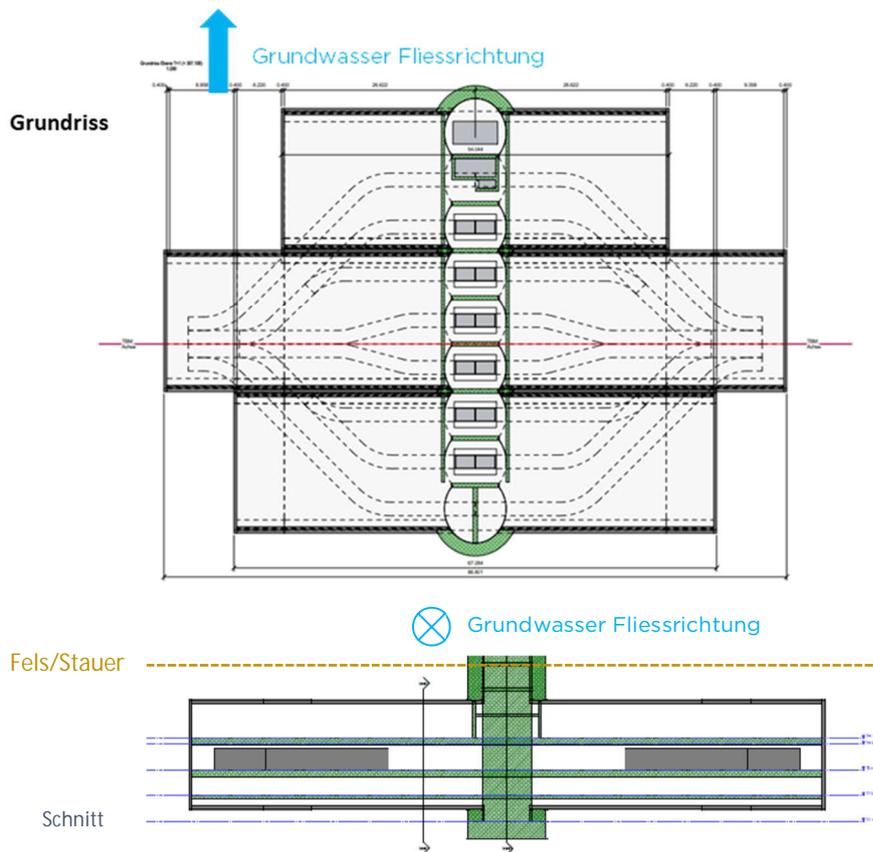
Schachtlösung zur Einhaltung der 10%-Regel. Oben Grundriss auf Tunnelniveau im Fels; unten: Schnitt durch die Kaverne auf Tunnelniveau. Detailplan im Anhang.
